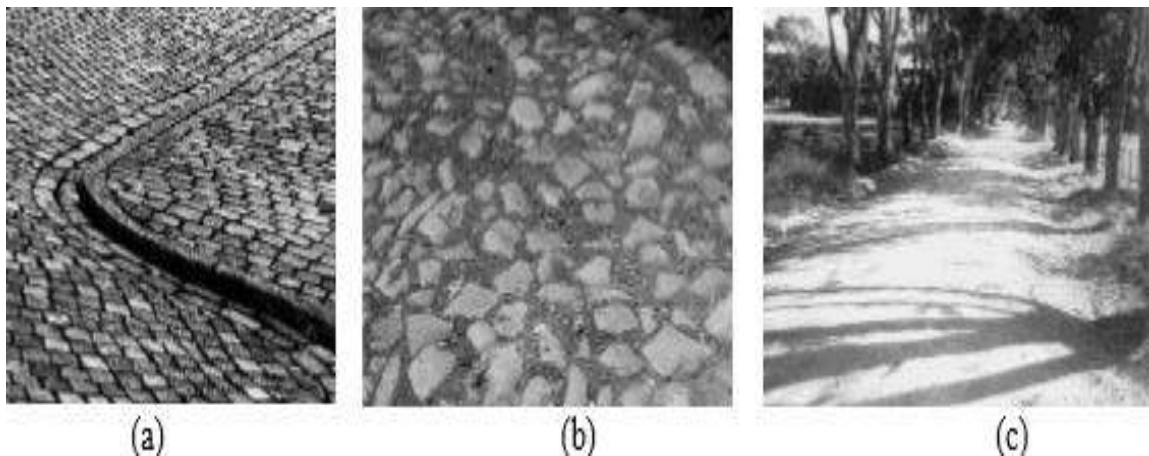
Otros tipos de pavimentos (a) adoquines, (b) empedrados, (c) suelo-cemento.
